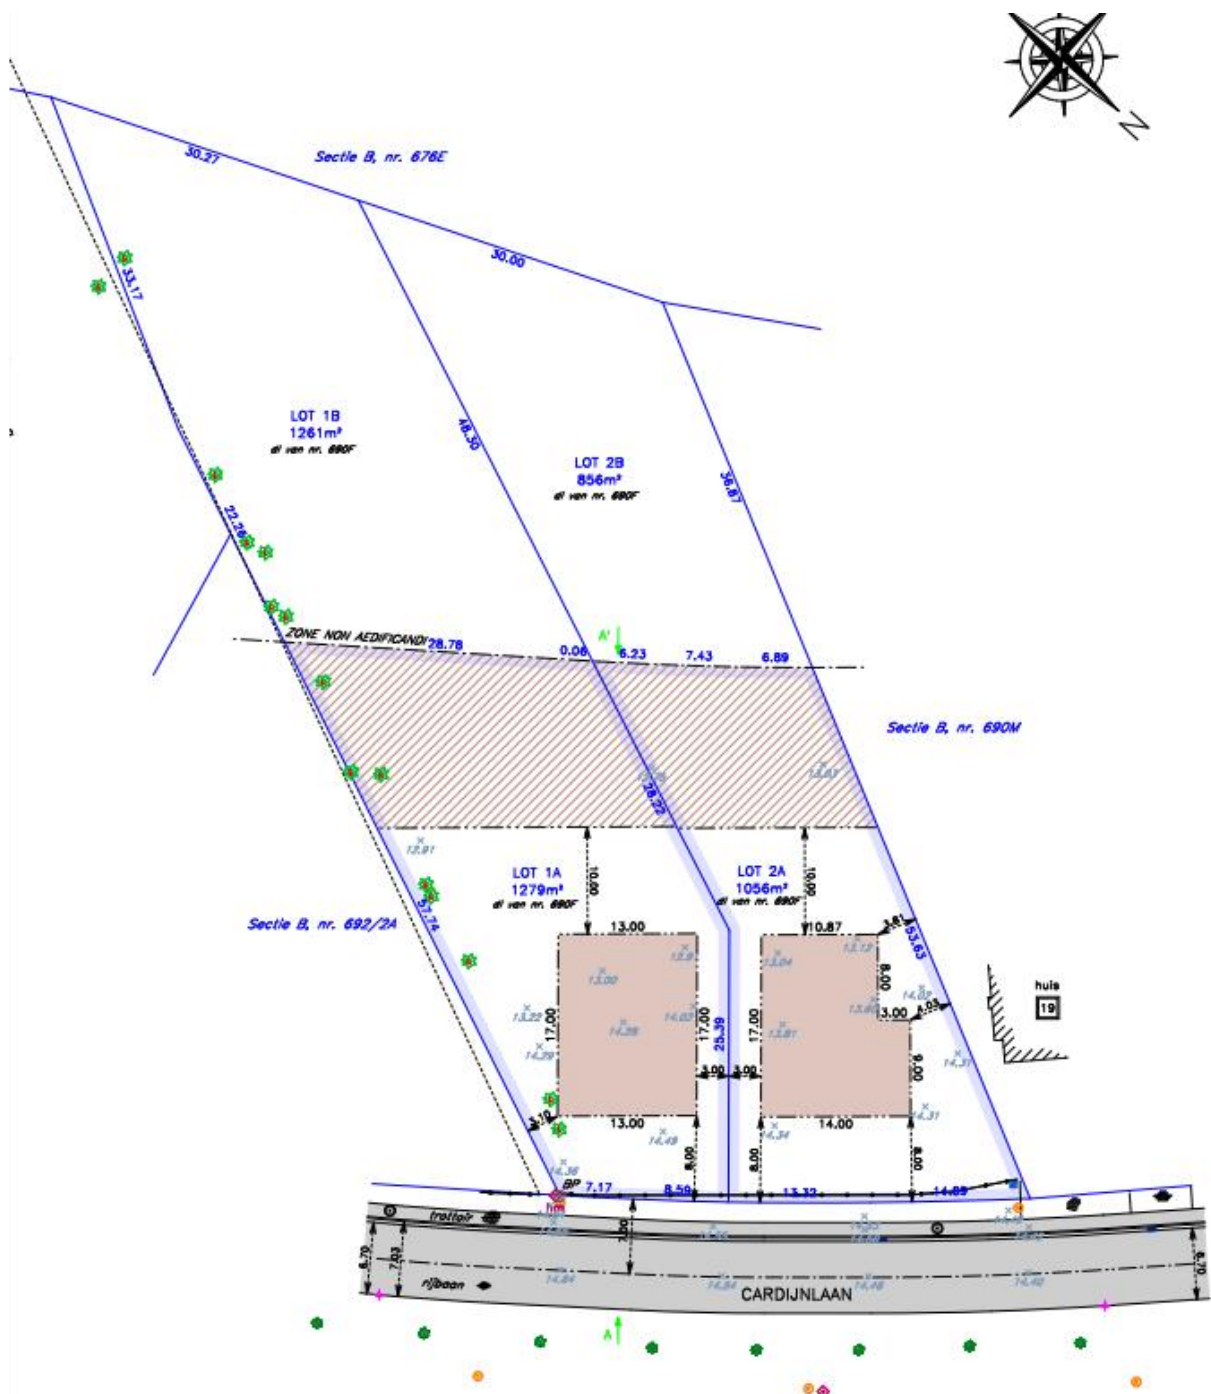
Inplantingsplan bestaande toestand. ©LARES
